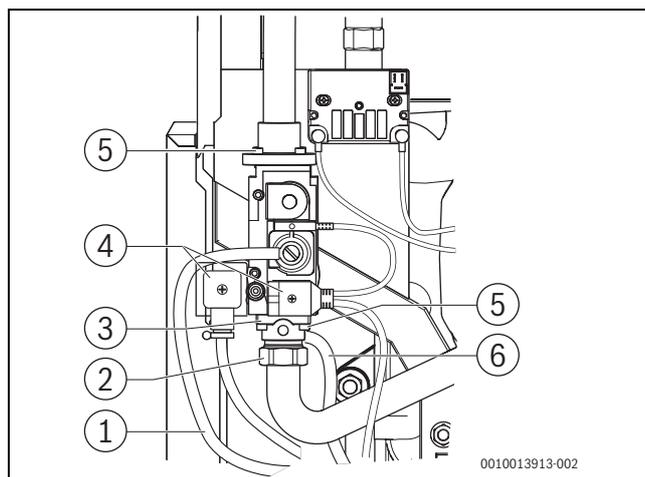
Allentare i collegamenti della valvola del gas (75°... 100 kW)
